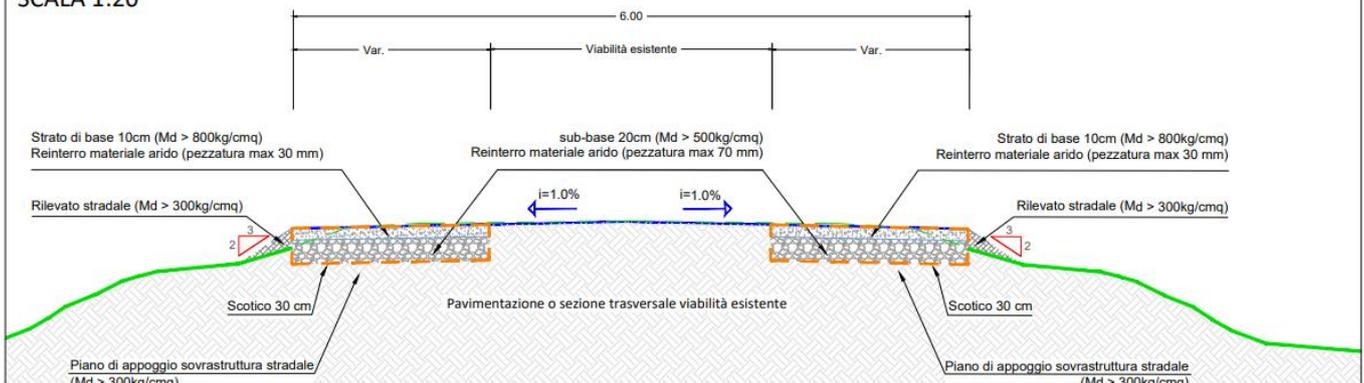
Sezione tipica viabilità esistente soggetta ad adeguamento
